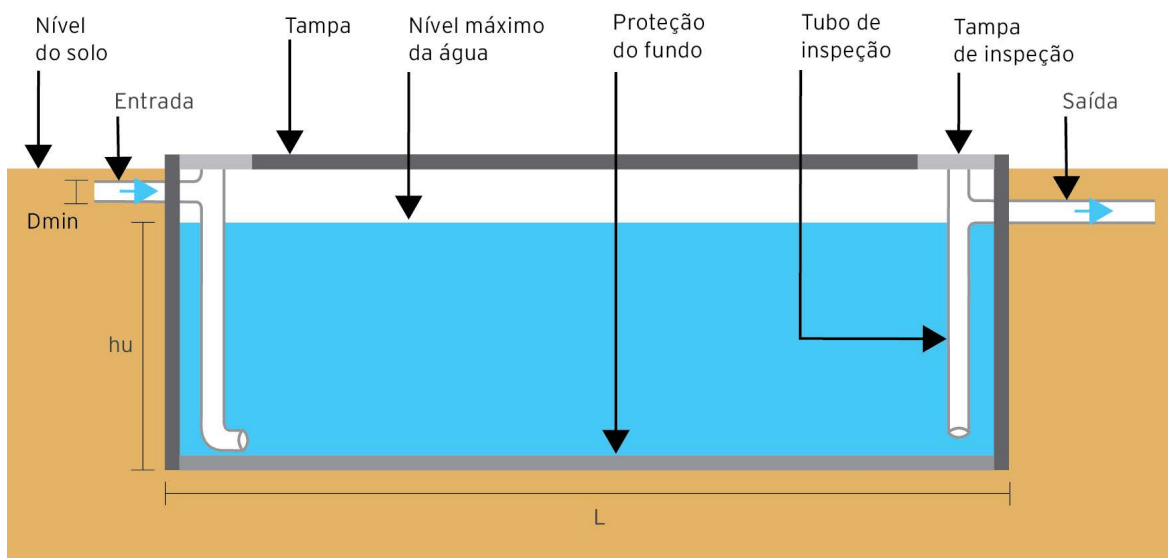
Trincheira de Infiltração sem Preenchimento - Corte Lateral.
